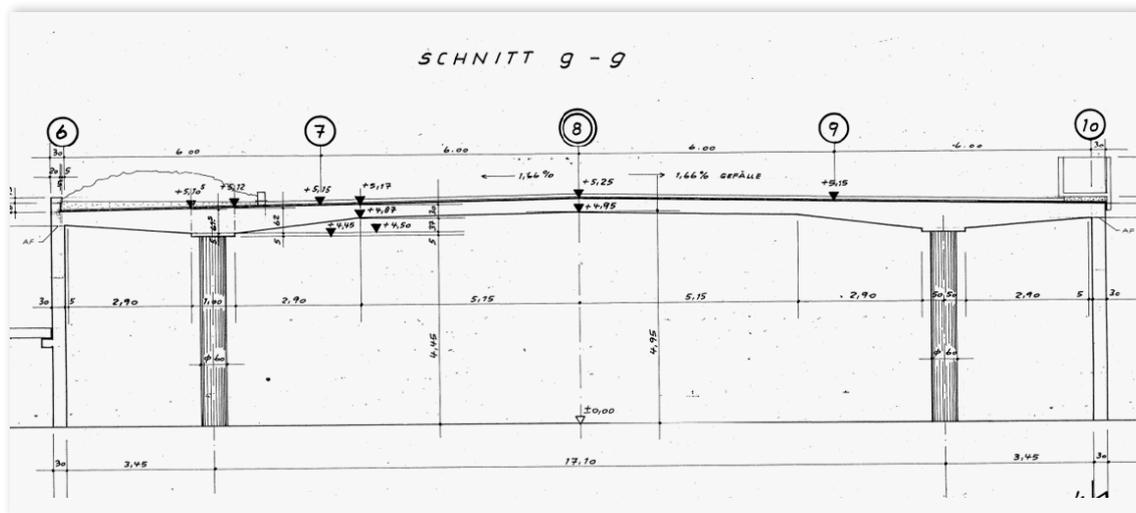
Bauwerksplan Grüne Brücke (Bestand)
